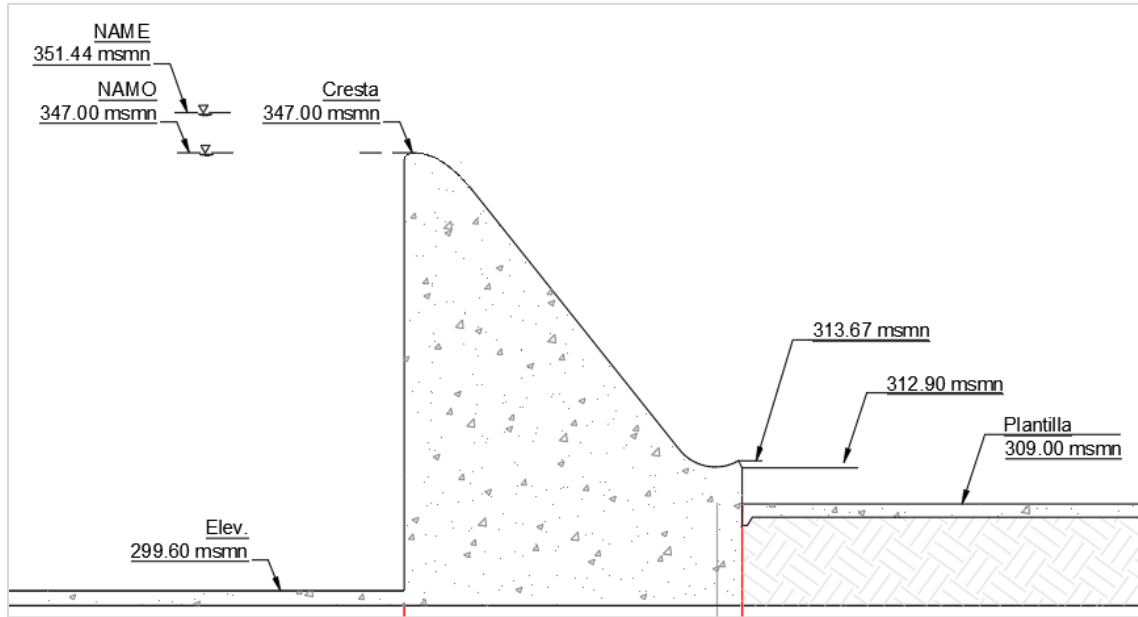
Detalle de elevaciones en la obra de excedencias
